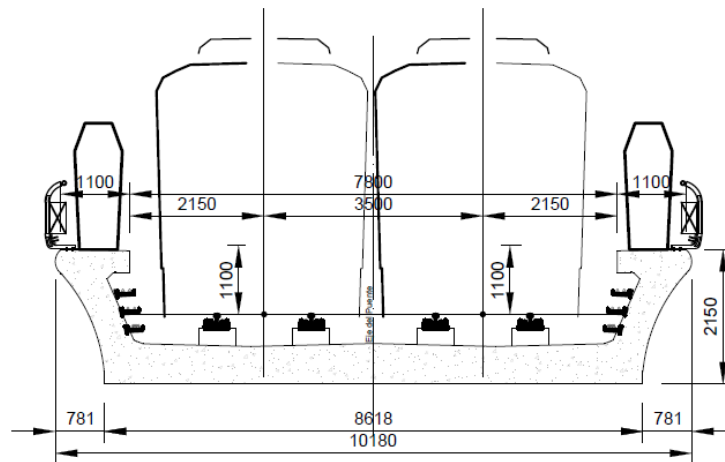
Perfil transversal (Sección en recta y radios > 3000 m)
